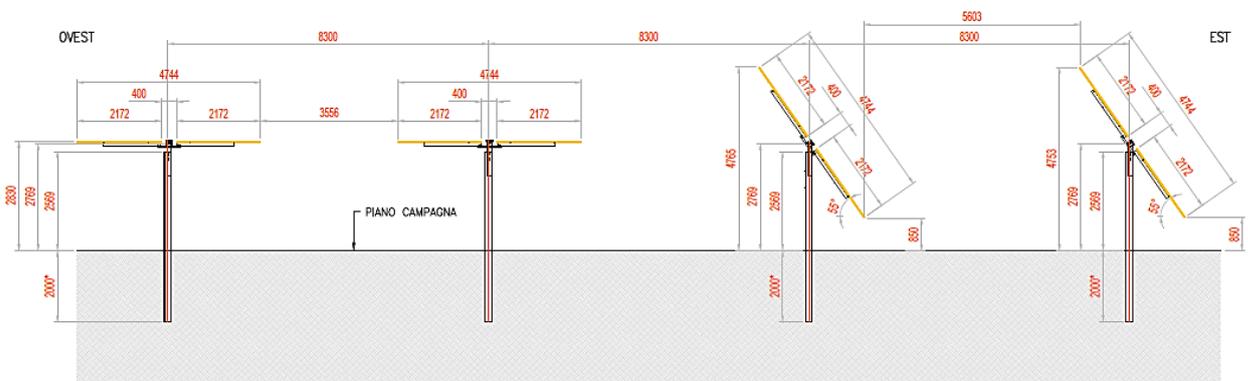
Particolare strutture di sostegno moduli, sezione trasversale.
